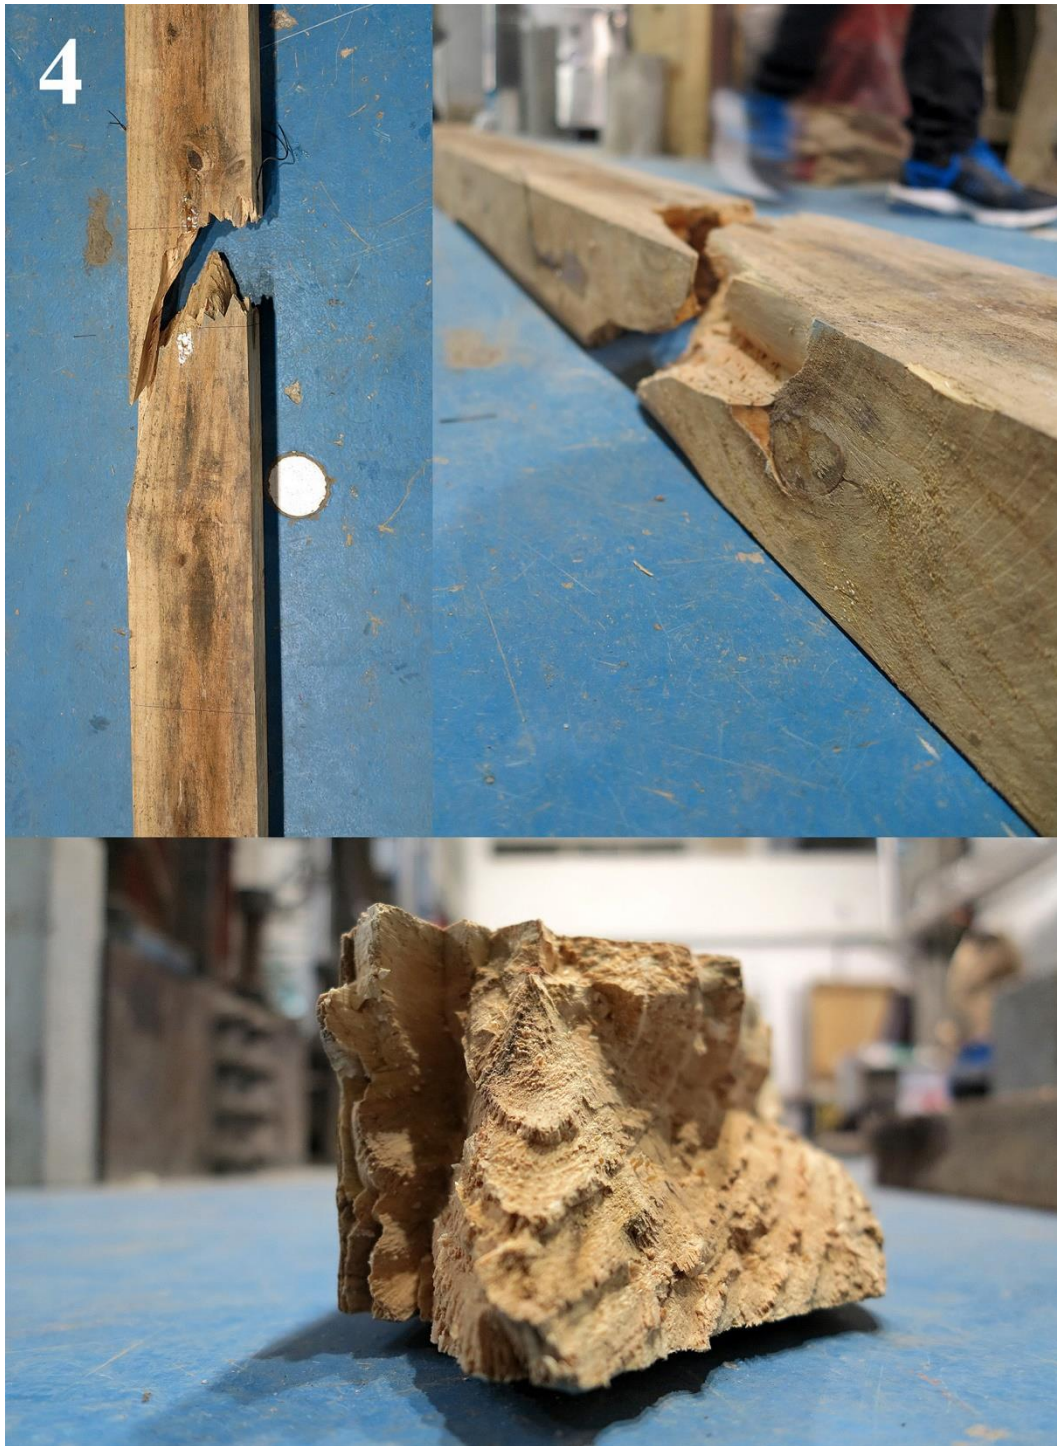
Viga 4 da série sem reforço após ensaio de flexão.
